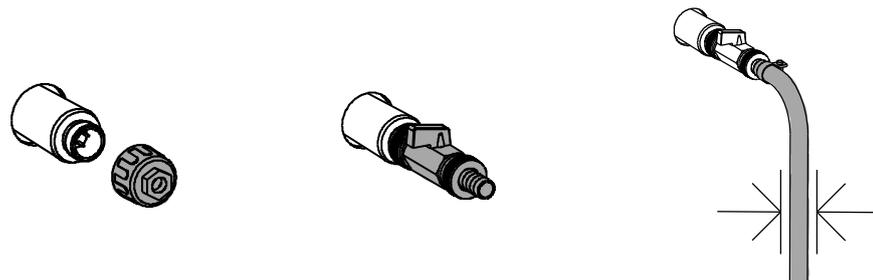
Bouchon de construction et montage de la robinetterie
